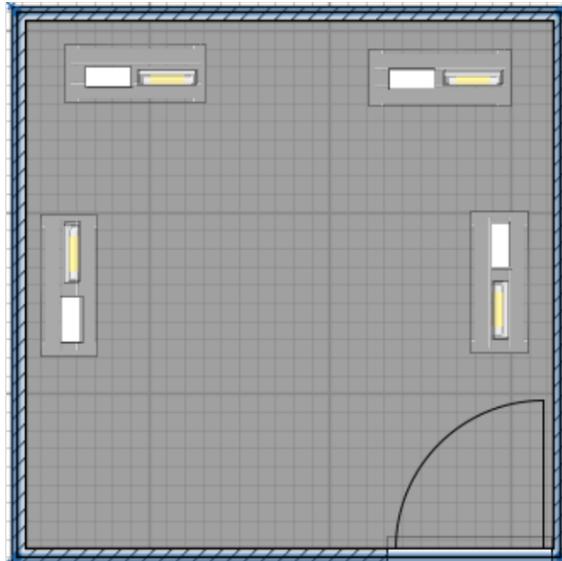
Vista interna de las mesas de vibración. Sweet Home 3D Ver.2018.
